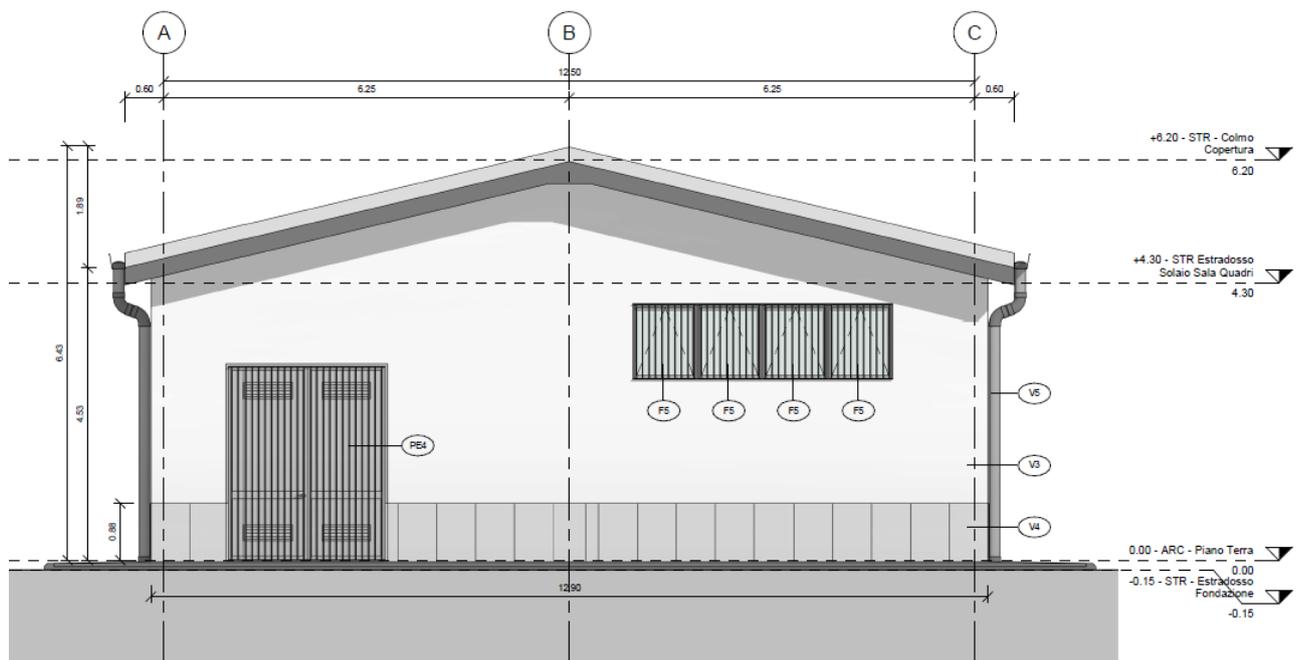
SSE Pieve Emanuele – Prospetto Nord
